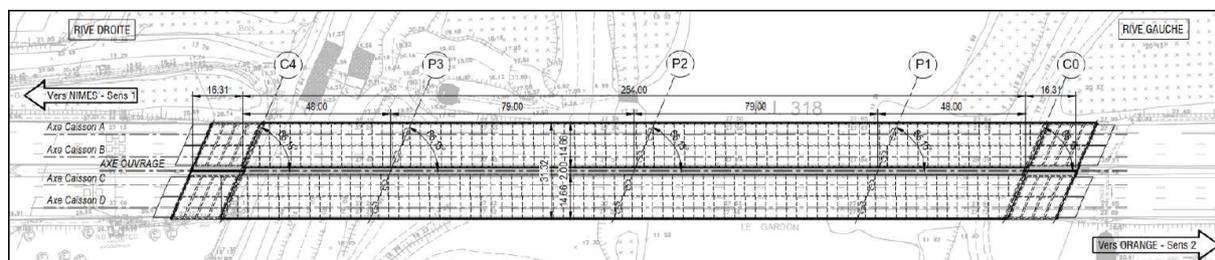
Vue en plan de l'ouvrage (Arcadis, 2022)
